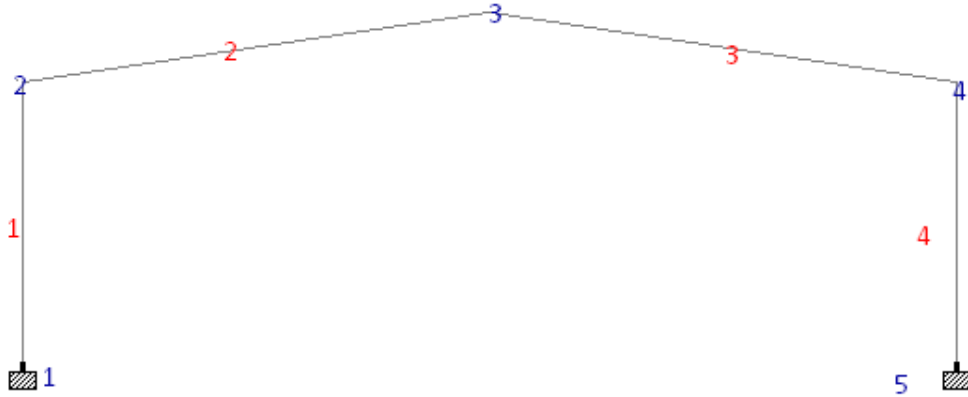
Axonometría pórtico típico, modelado en StaadPro.
